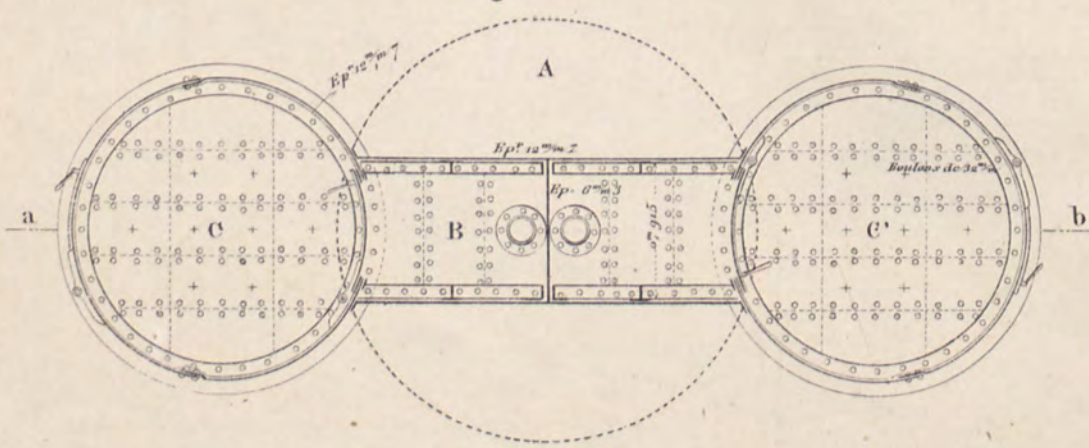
PLAN GÉNÉRAL DE LA PILE.
